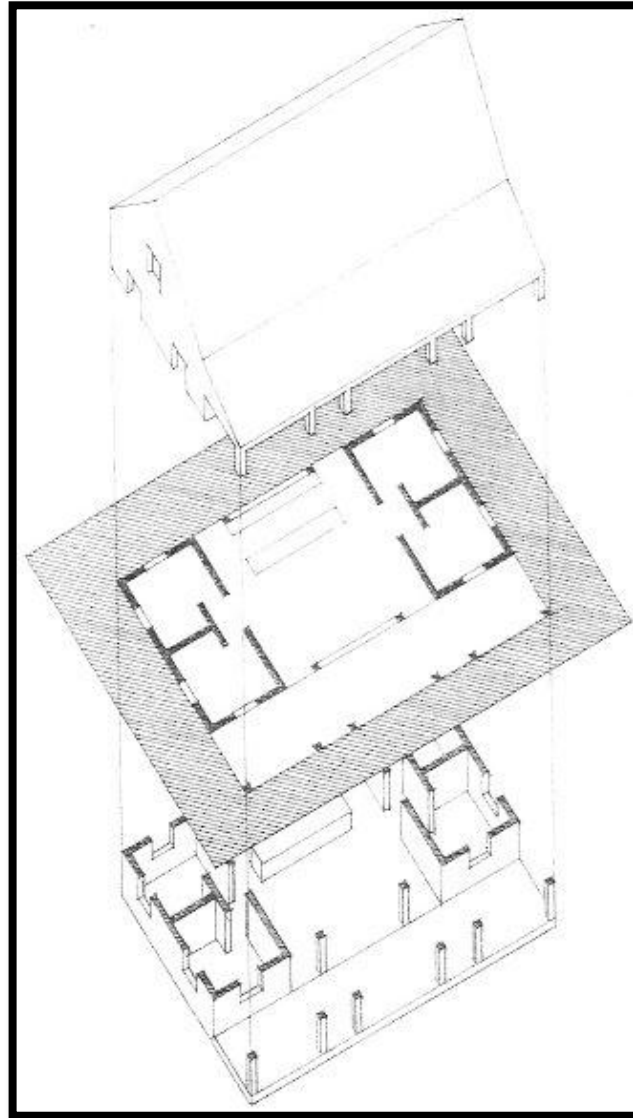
Proyección de planta arquitectónica, Fuente: (Rangel Y.,2006, Pág.05)
